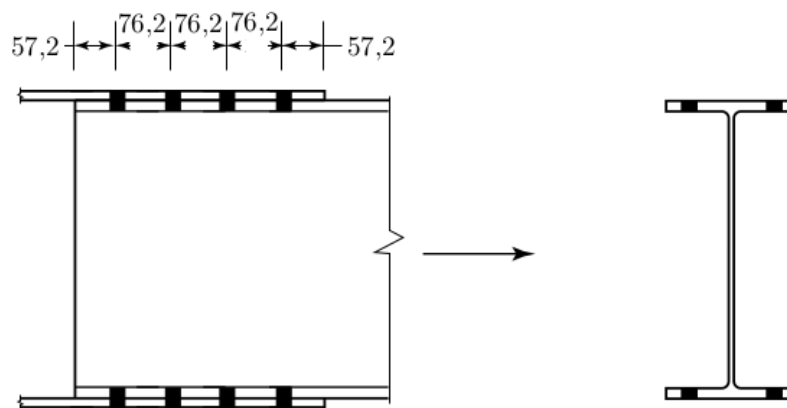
Perfil W conectado pelas mesas, esquema de furação.
